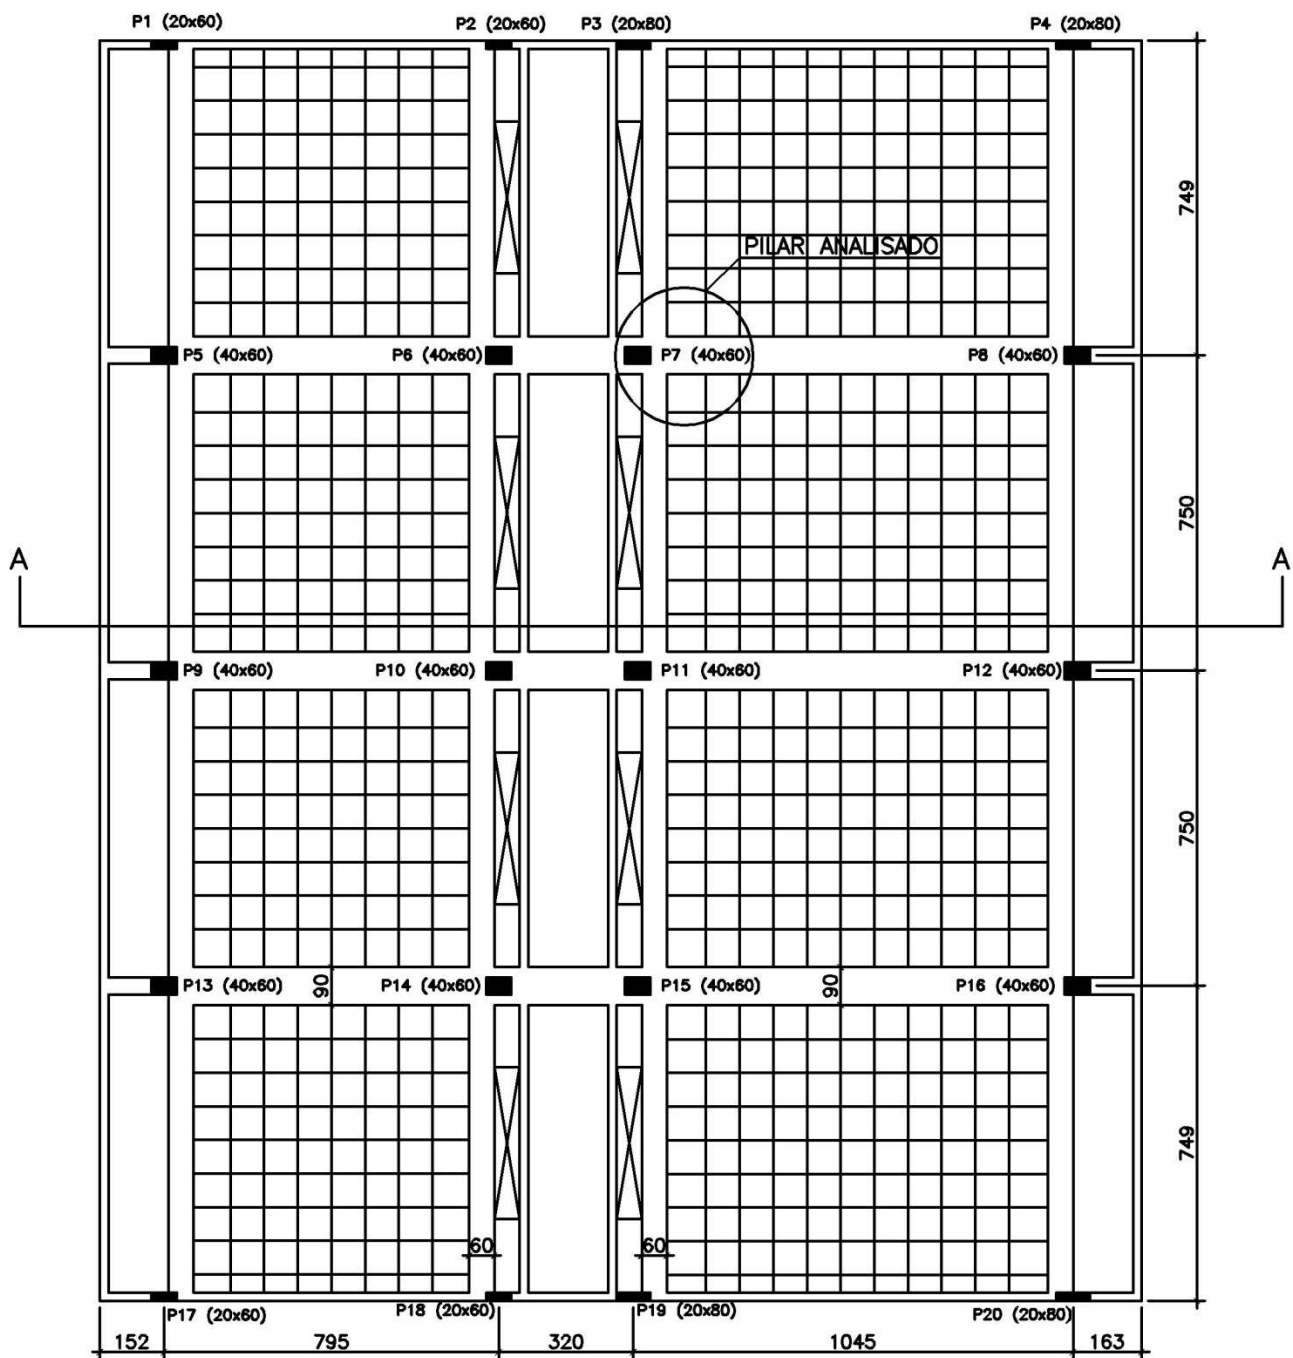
Planta baixa esquemática da edificação em estudo.
